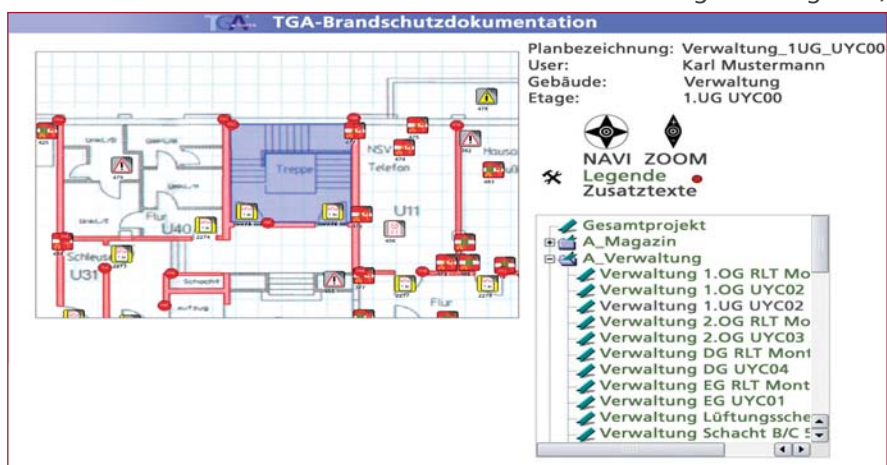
Beispielplan auf Grundlage einer eingescannten Zeichnung mit nachträglich erstelltem Brandschutzplan und Kennzeichnung der Mängel- oder Dokumentationspunkte
